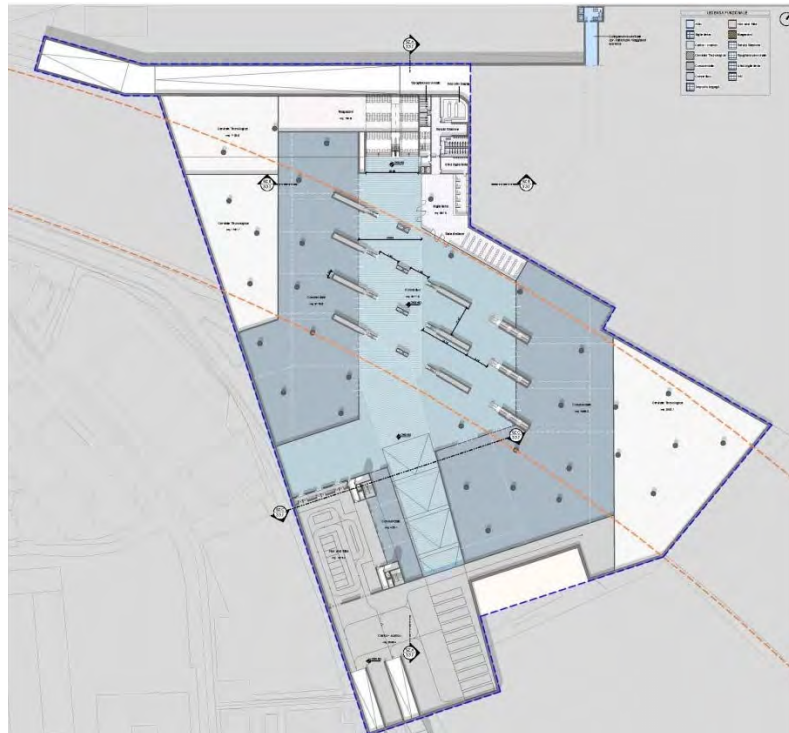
Estratto Tav 3.3.1 – Pianta Piazza Ipogea
